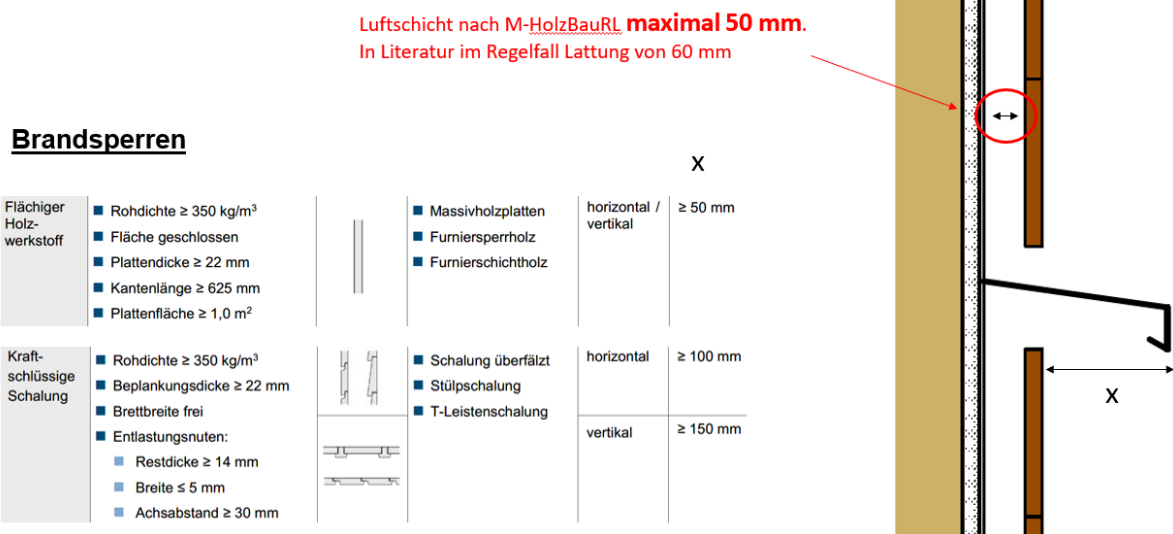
Horizontale Schottung einer Holzfassade (M-HolzBauRL)
